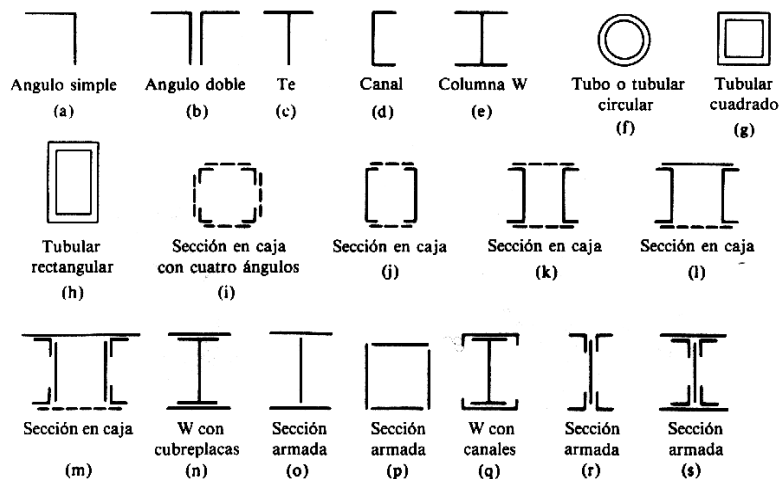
Secciones transversales típicas de columnas de acero (McCormac, 1996, p.99).
